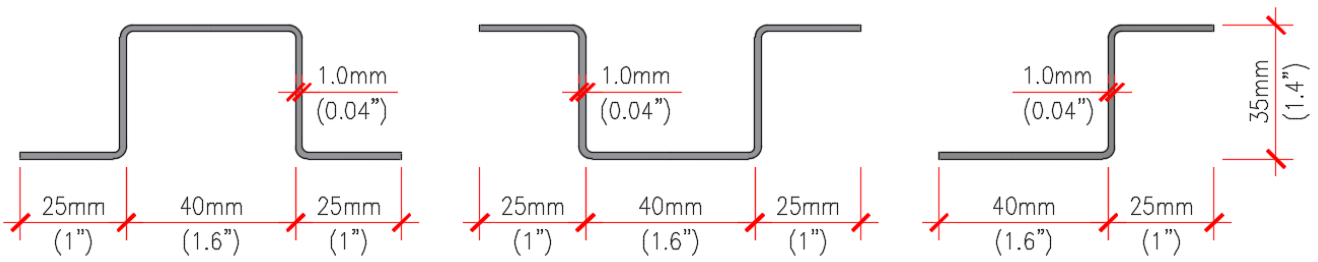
Secção tipo de estrutura em aço galvanizado DX51D (Z+)
